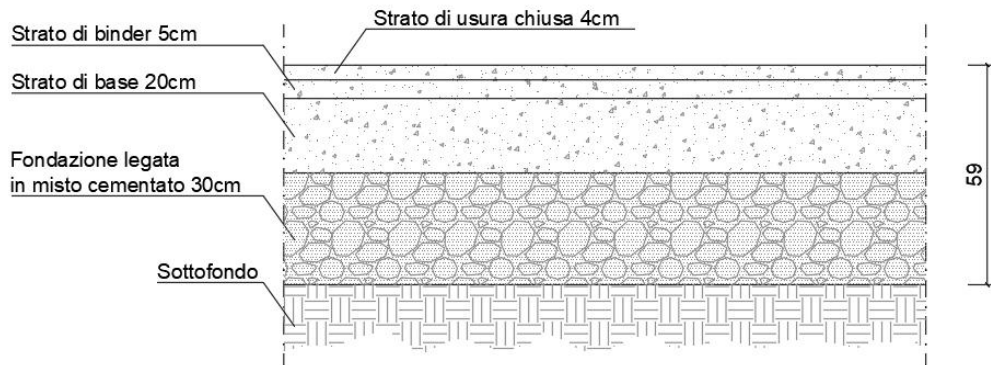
Pacchetto di ripristino pavimentazione nelle viabilità locali - TIPO P5C
